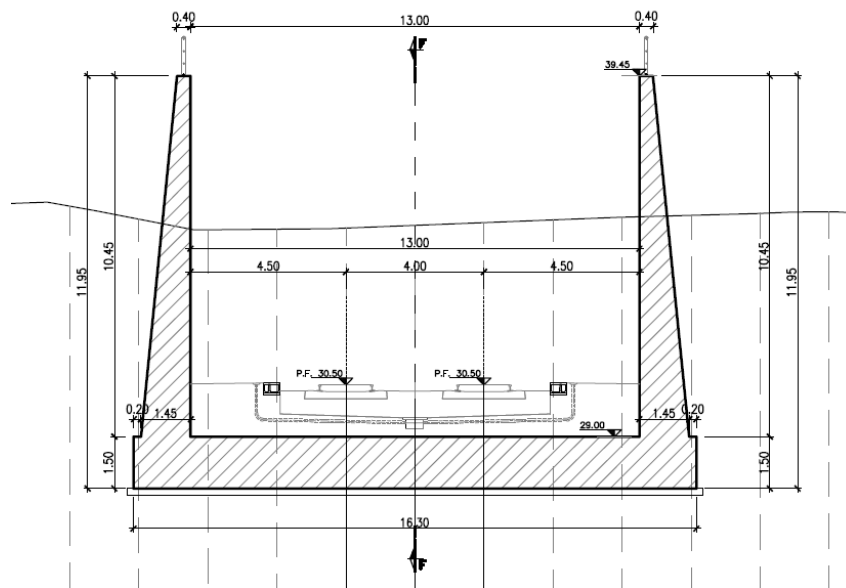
Sezione muro di imbocco (Hmax=10.45 m)
